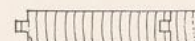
Riemen mit stehenden Jahresringen für Fußböden am besten, da nicht splinternd
